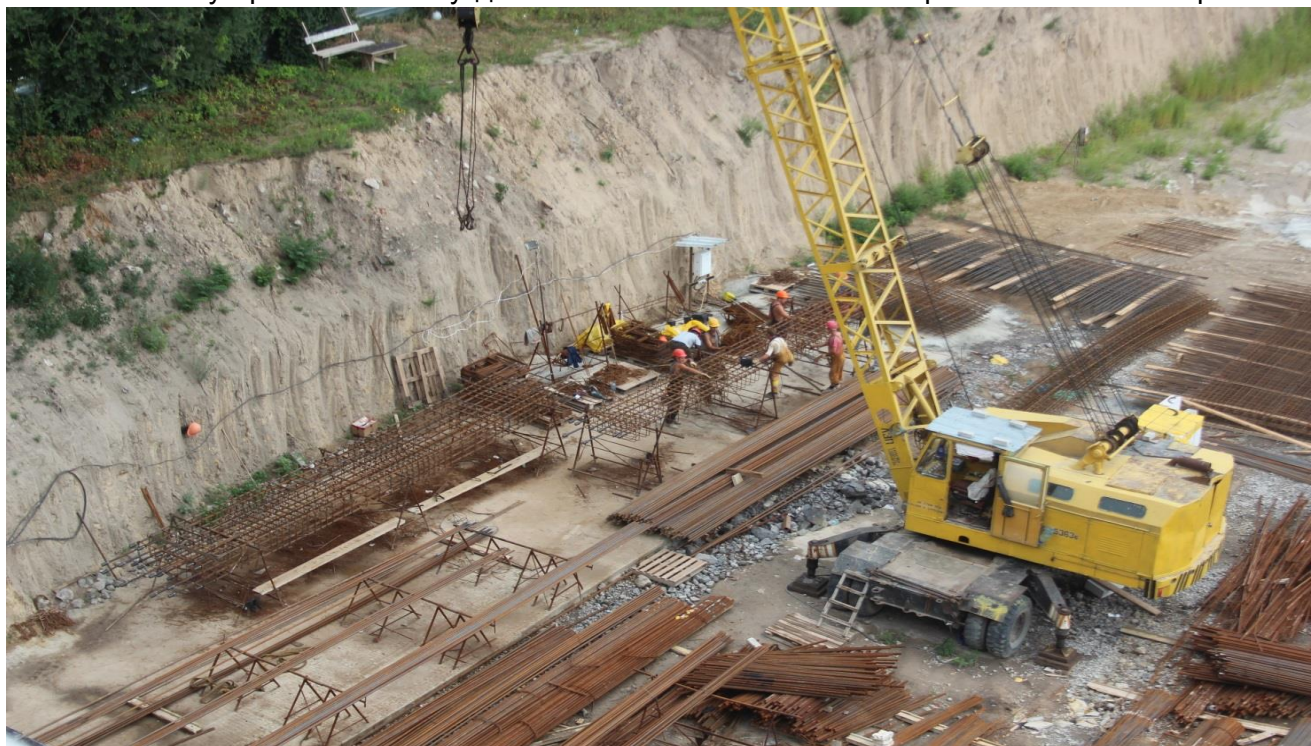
Общий вид арматурной площадки по изготовлению каркасов
